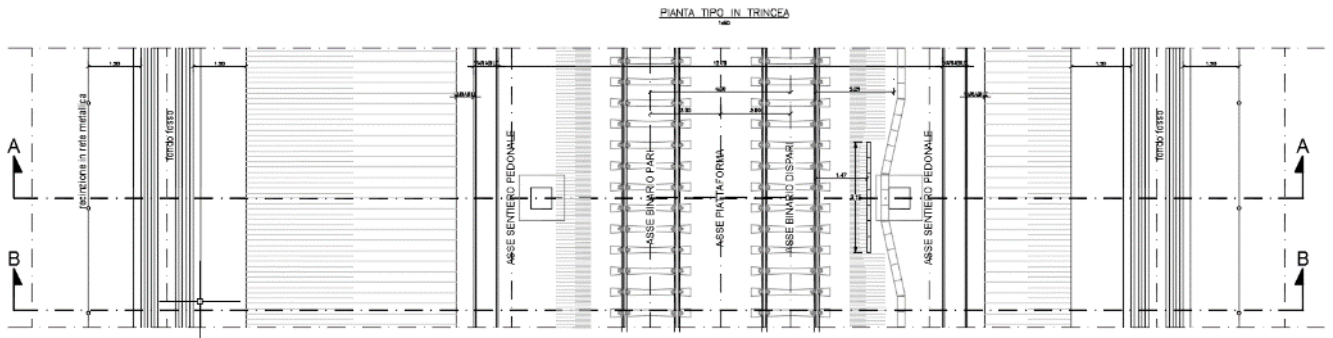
Pianta tipo della linea ferroviaria in trincea
